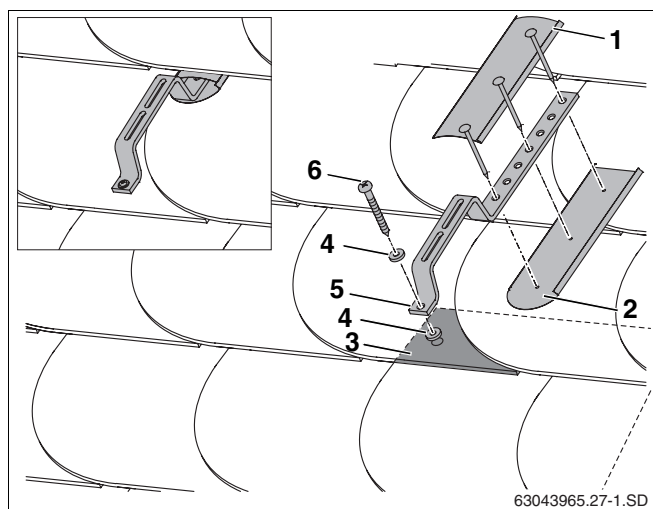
Montaje sobre cubierta de pizarra o chillas
